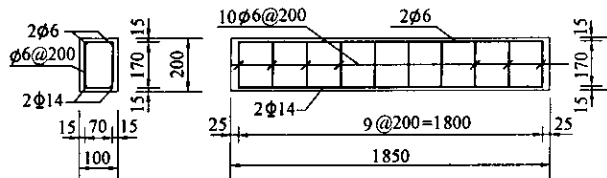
钢筋混凝土梁配筋情况示意图(单位: mm)
